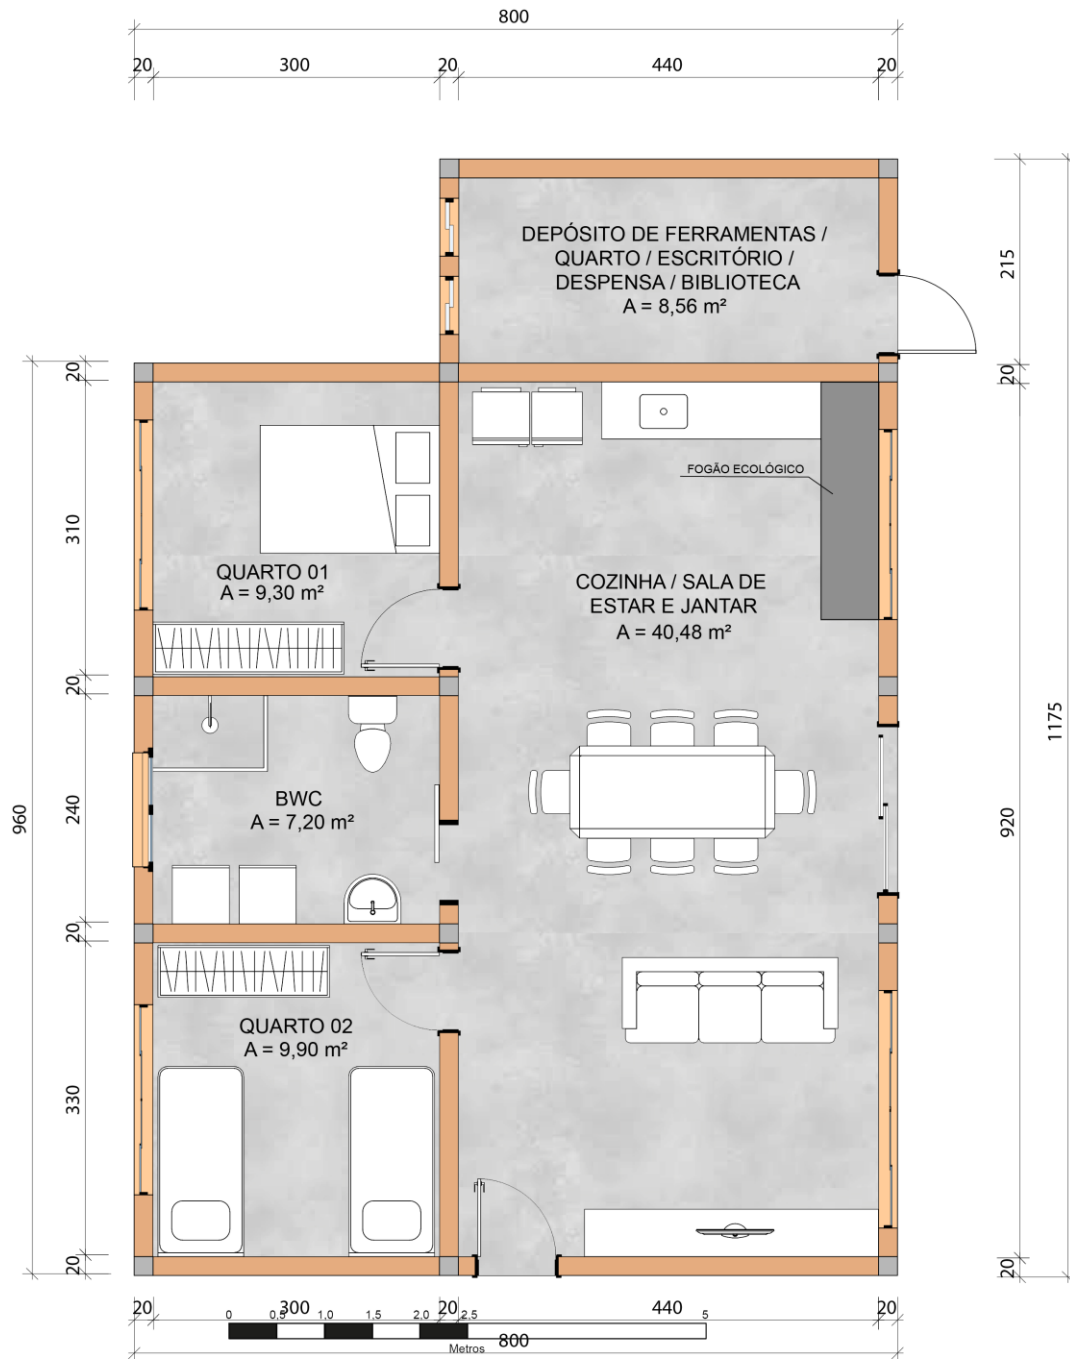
Planta baixa do protótipo de habitação de cunho permacultural.
